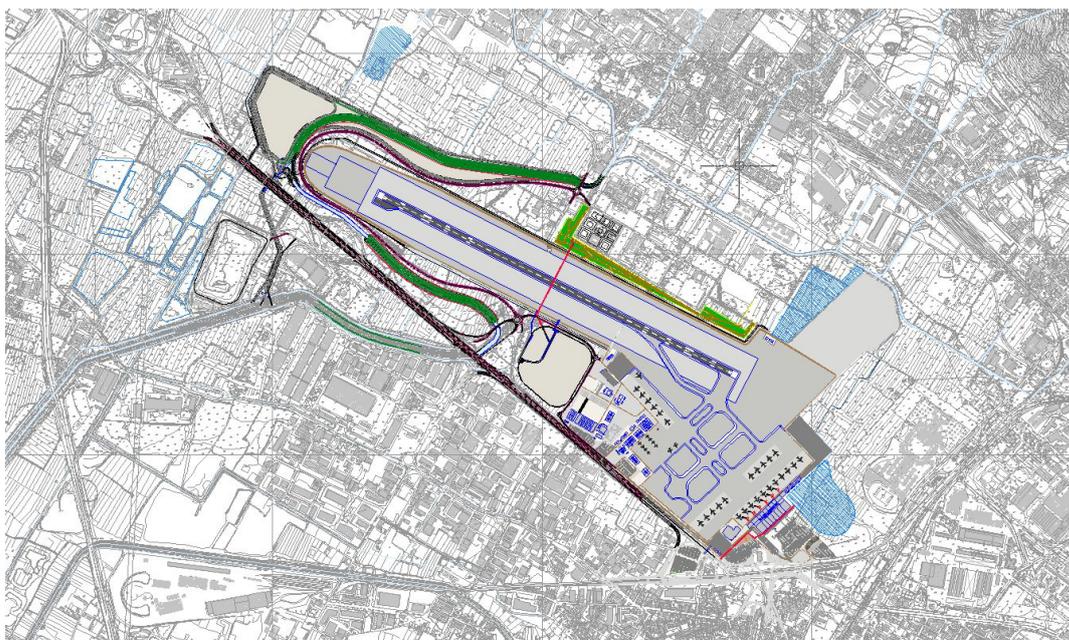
stralcio della planimetria di progetto dell'Aeroporto "Amerigo Vespucci"
